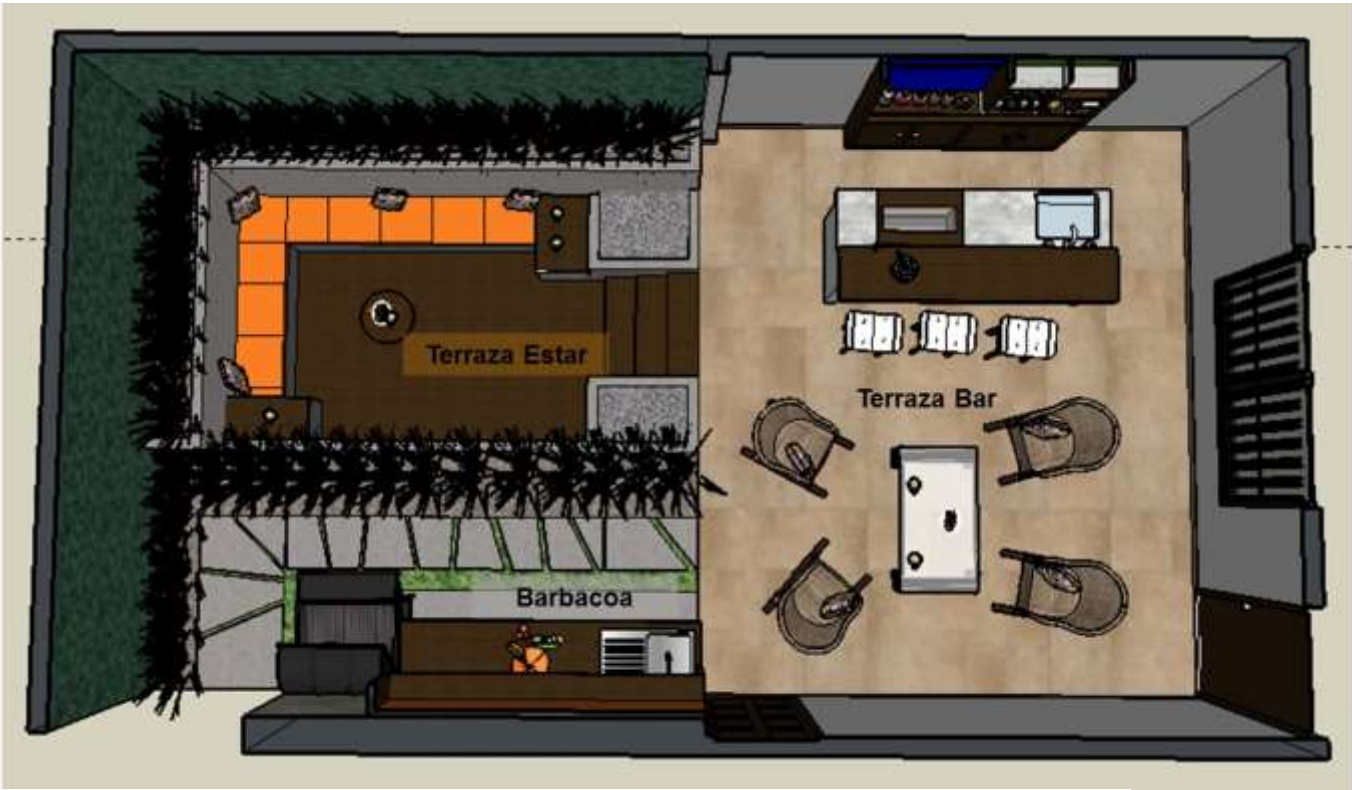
Distribución en planta de Terraza jardín. Fuente: Celeste Urrutia 2017
